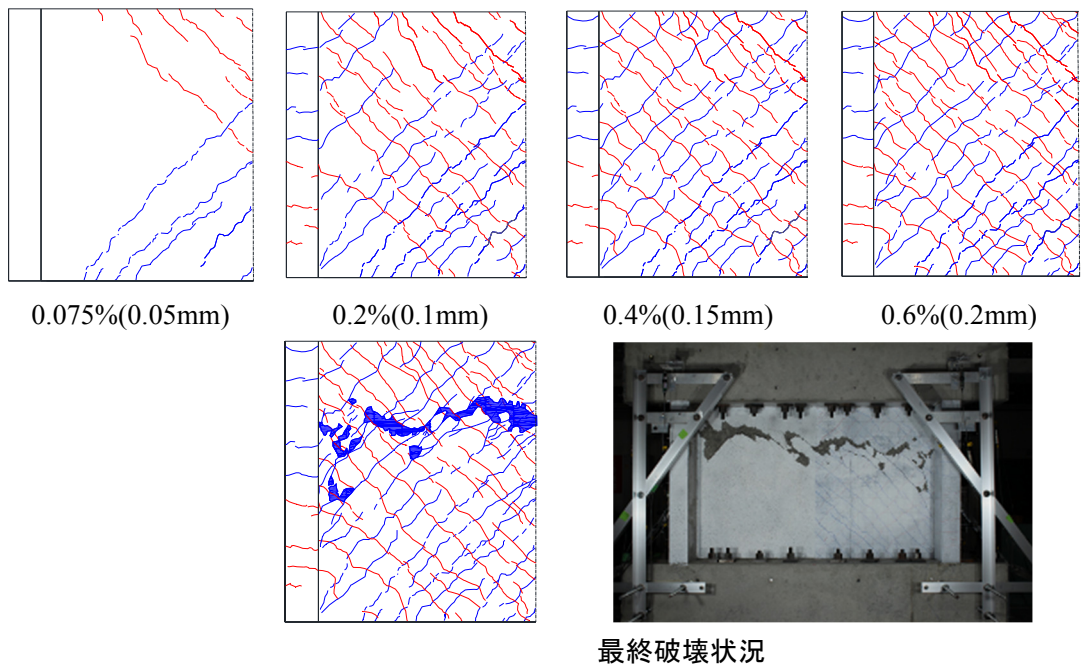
ひび割れ及び破壊状況 (直交壁付き SF-13-D0試験体)
